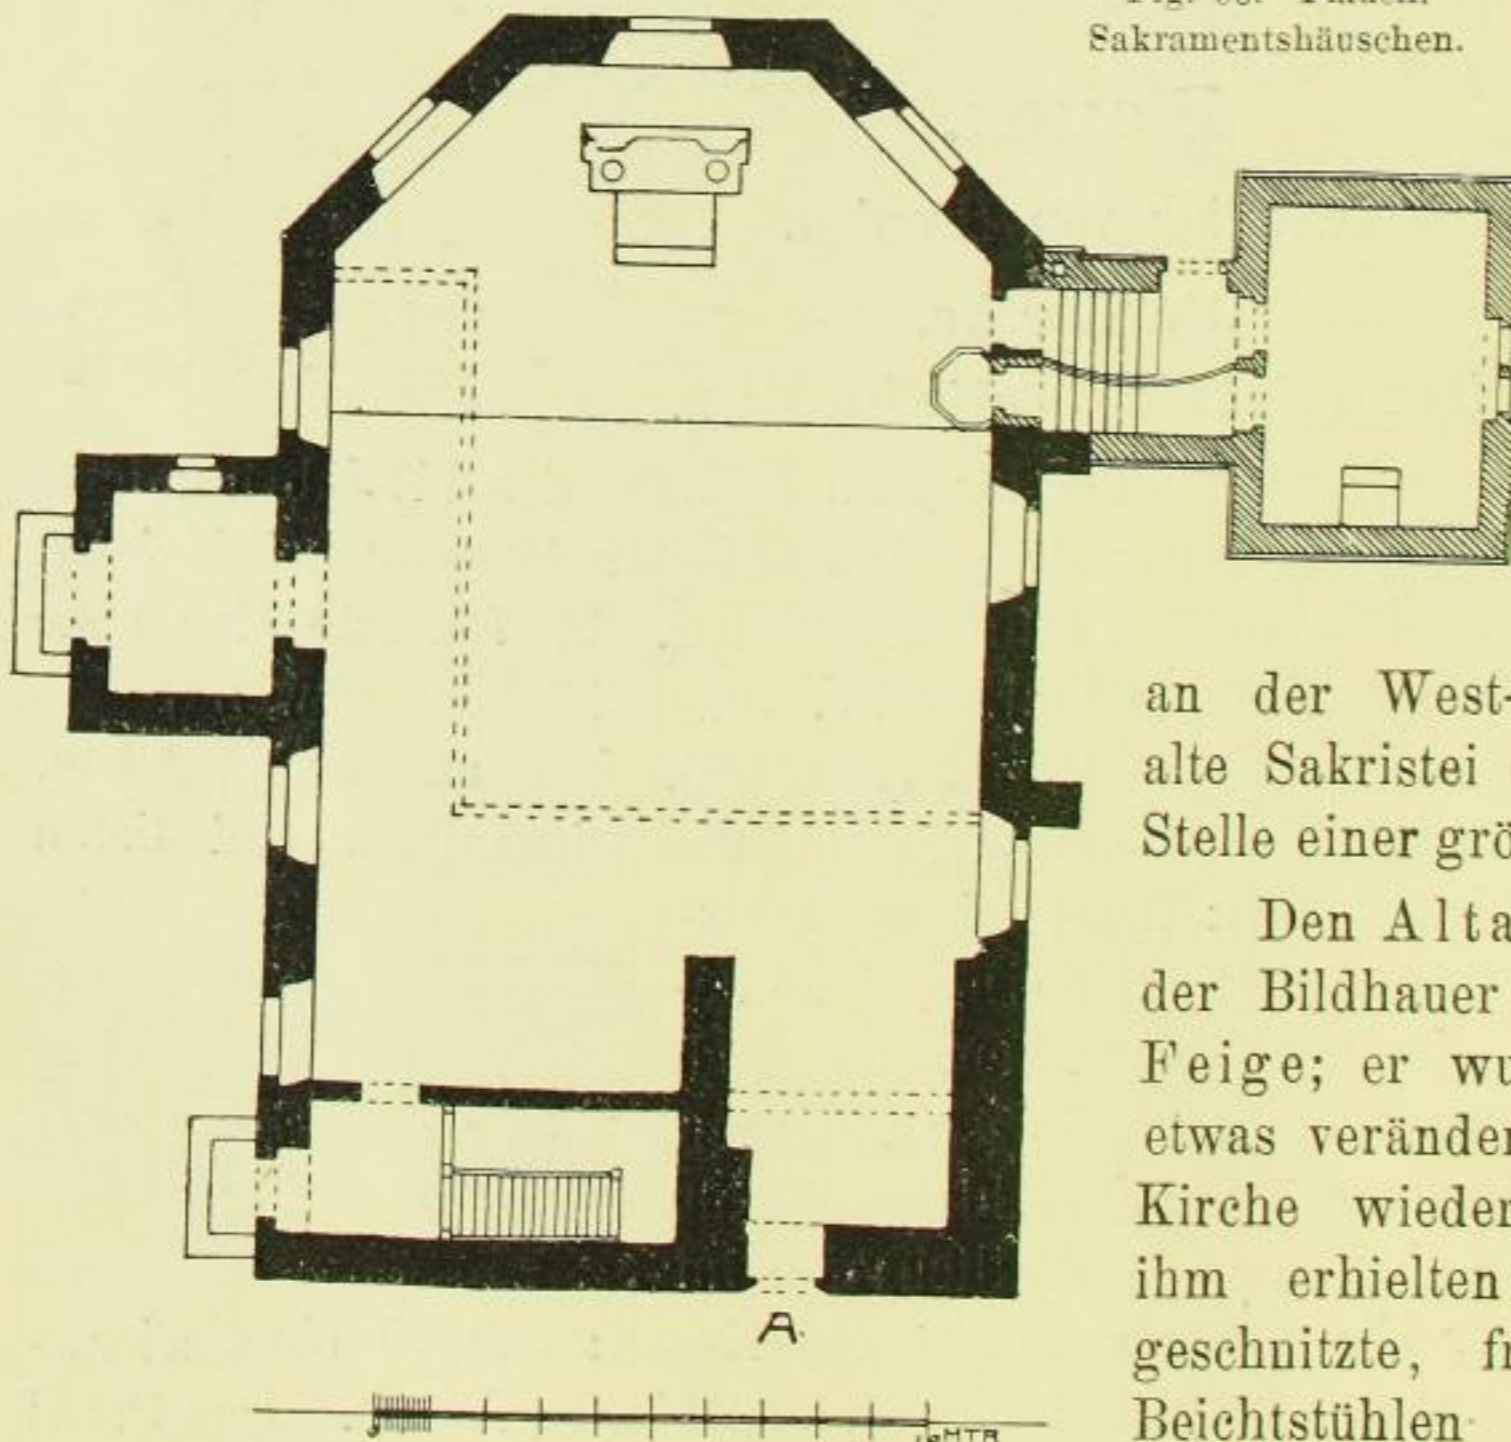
Plauen, Grundriss der Kirche, Zustand vor 1900.
